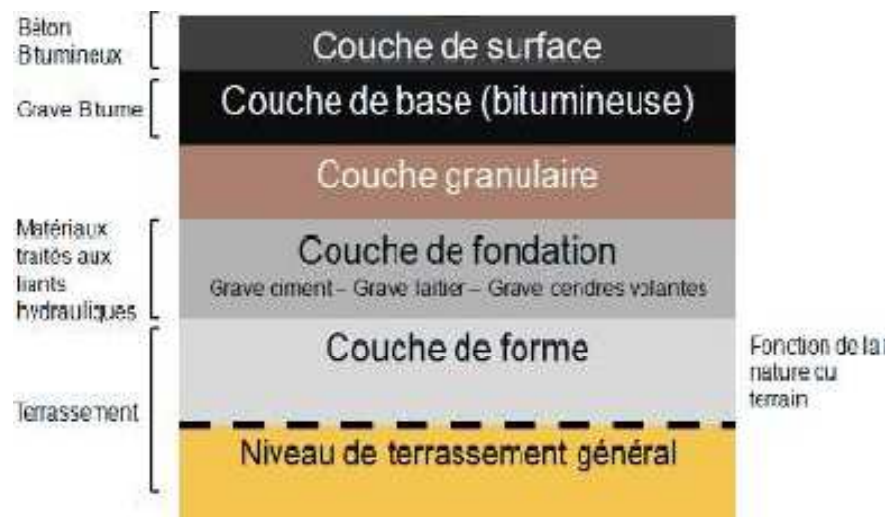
I. Constitution d'une chaussée à structure semi-rigide.
